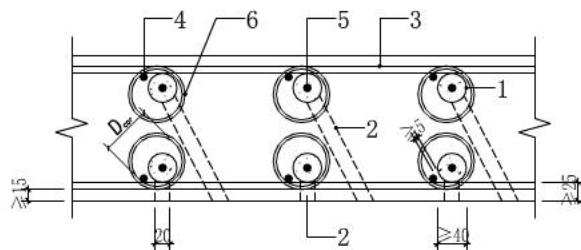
浆锚搭接钢筋连接接头构造示意
